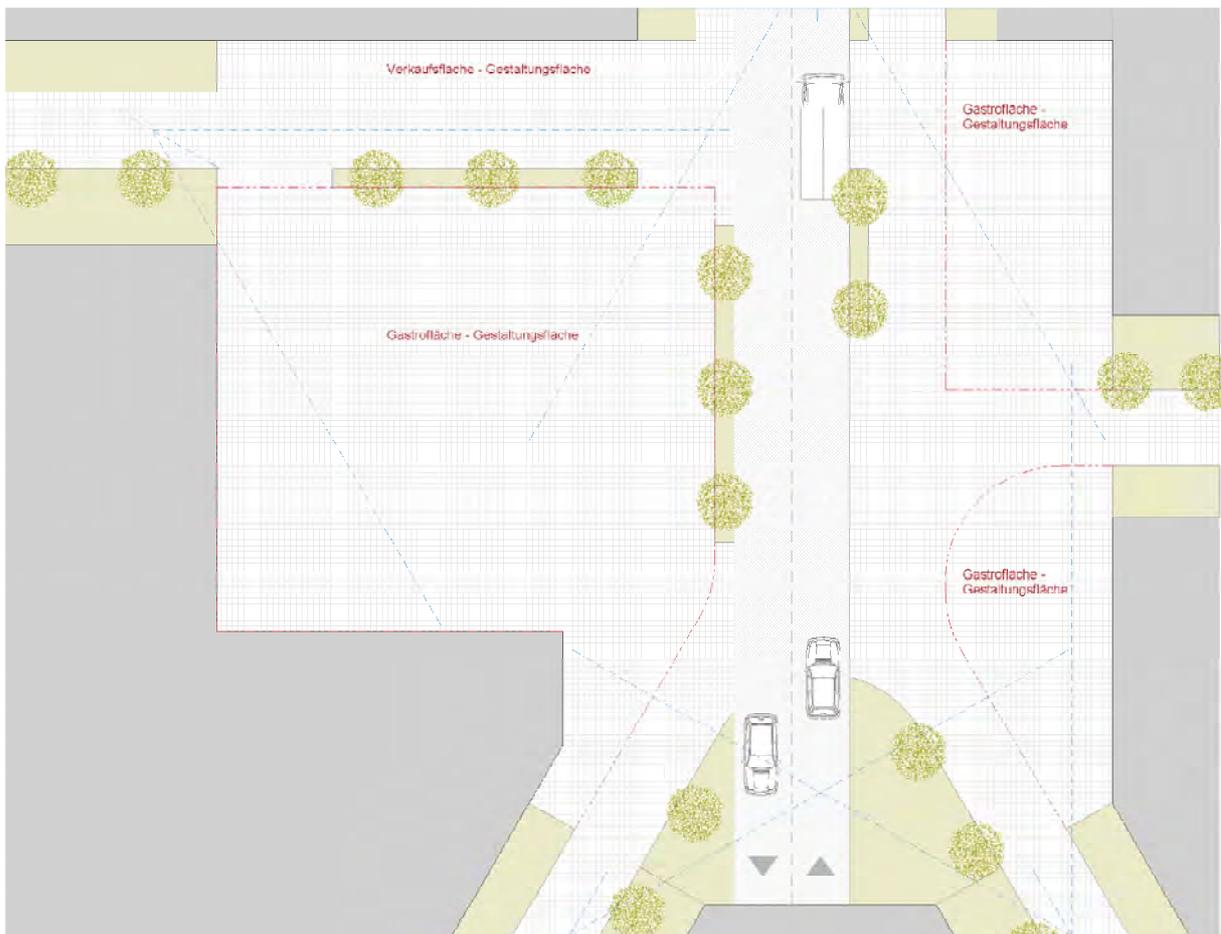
Grundrissdarstellung eines öffentlichen Platzes
